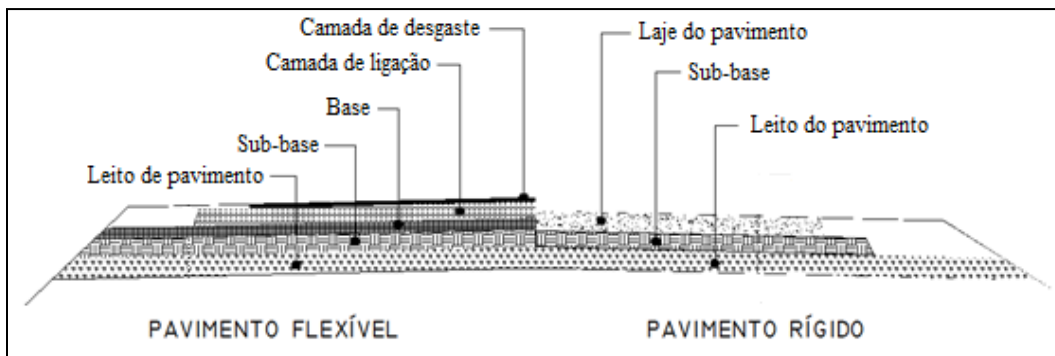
Estrutura em camadas dos pavimentos rodoviários
